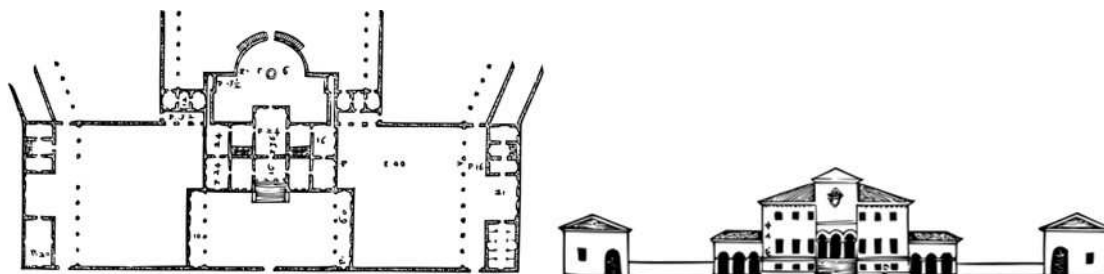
Villa Godi, Planta e Alçado, Lonredo. (Palladio, 1570)
